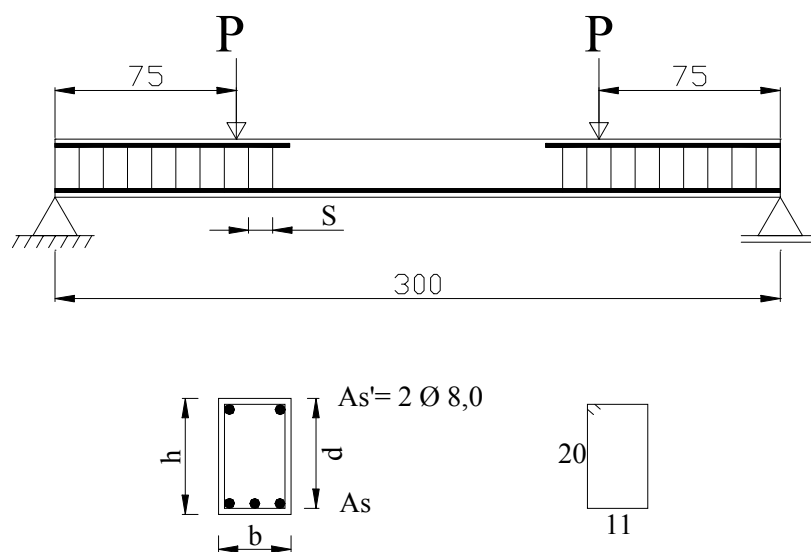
Geometria e carregamento das vigas ensaiadas por Decanini (apud Real, 2000).
